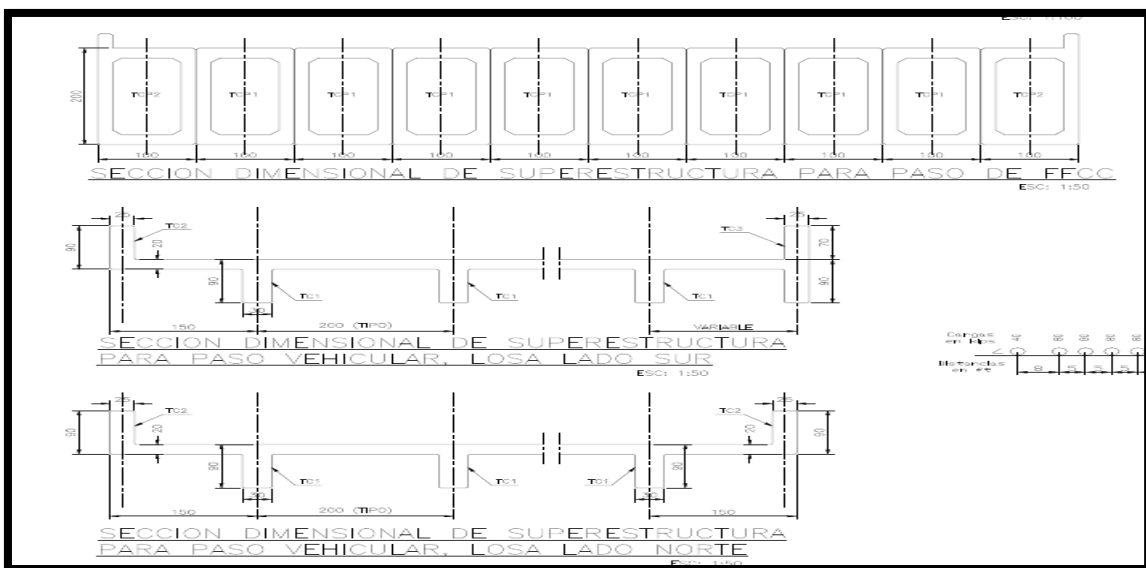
Sistema constructivo de la Super estructura del PIV "Santa Rosa".
